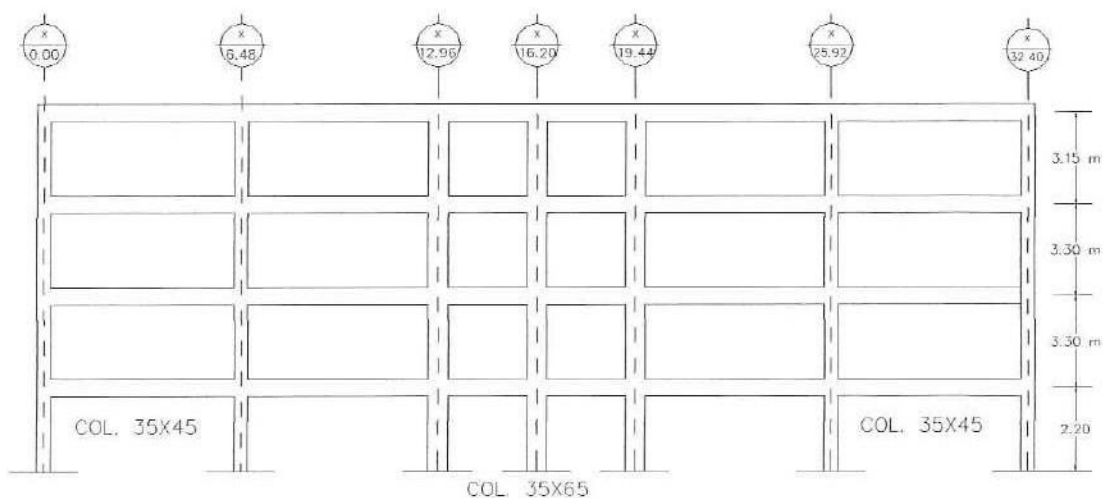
Edificio tipo para aulas en la UABC (Vista en Elevación).
